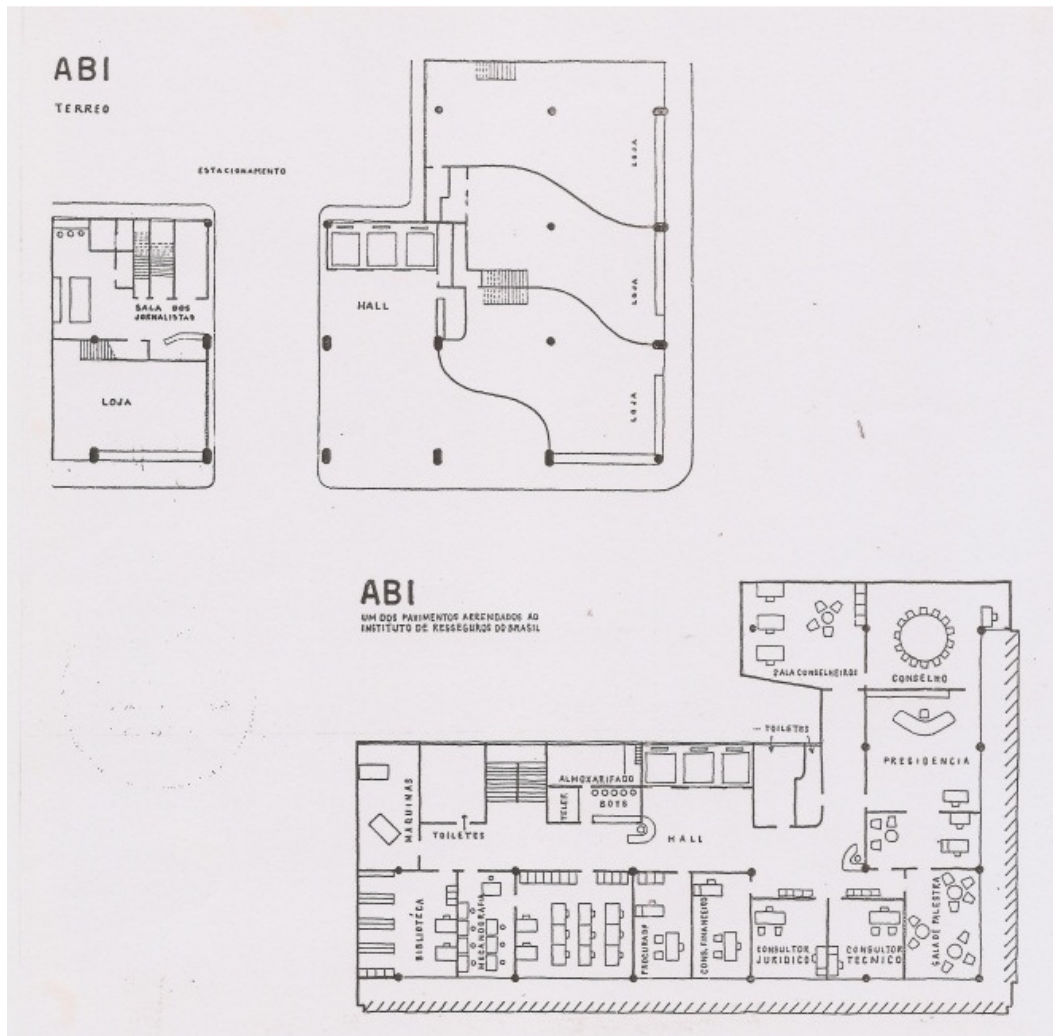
F – Plantas baixas pavimento térreo e dos pavimentos destinados à locação
